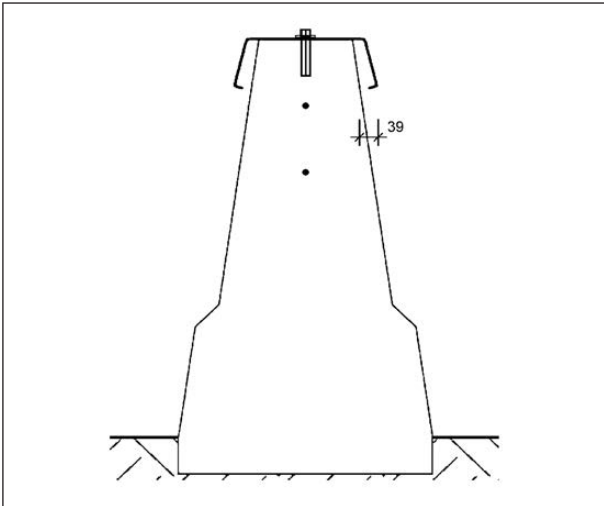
BSW O im Step 90 Profil mit 2 Ø 12 mm Bewehrung in 5 cm tiefer Asphaltnut eingespannt; Quelle: DEKRA
